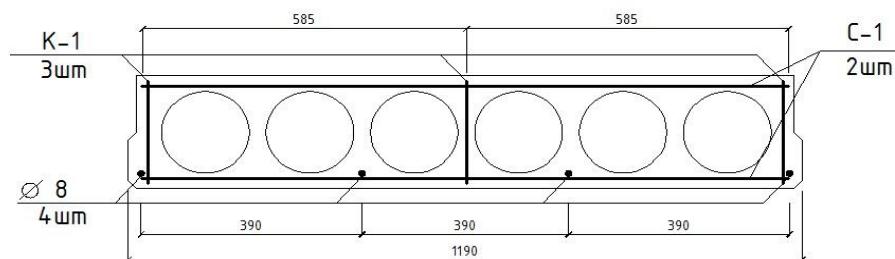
Схема армирования плиты продольной рабочей арматурой.
